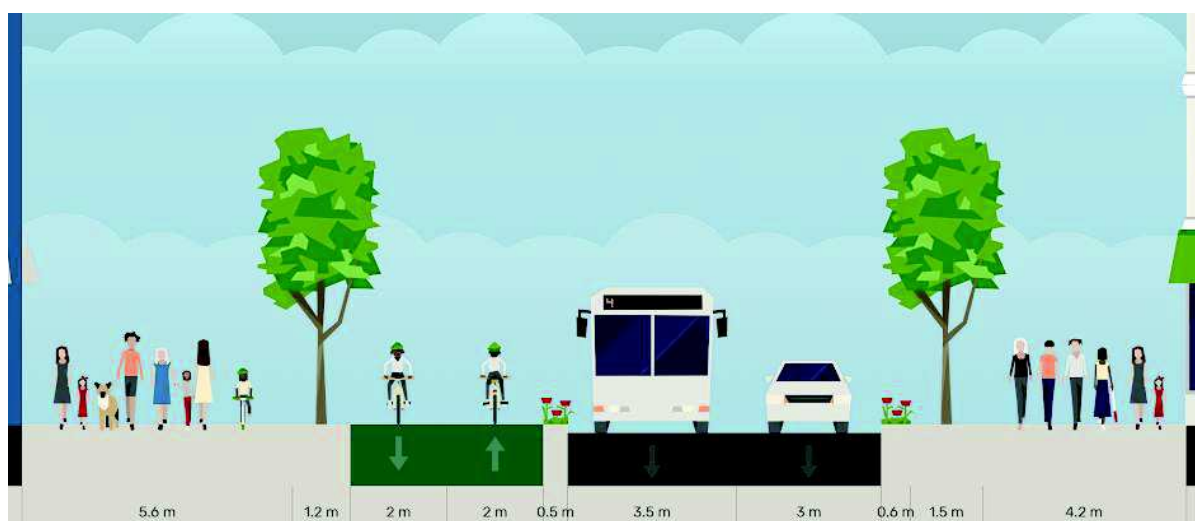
Sección propuesta para la Ronda Histórica en la Puerta Osario, a la altura de Muñoz Torrero
